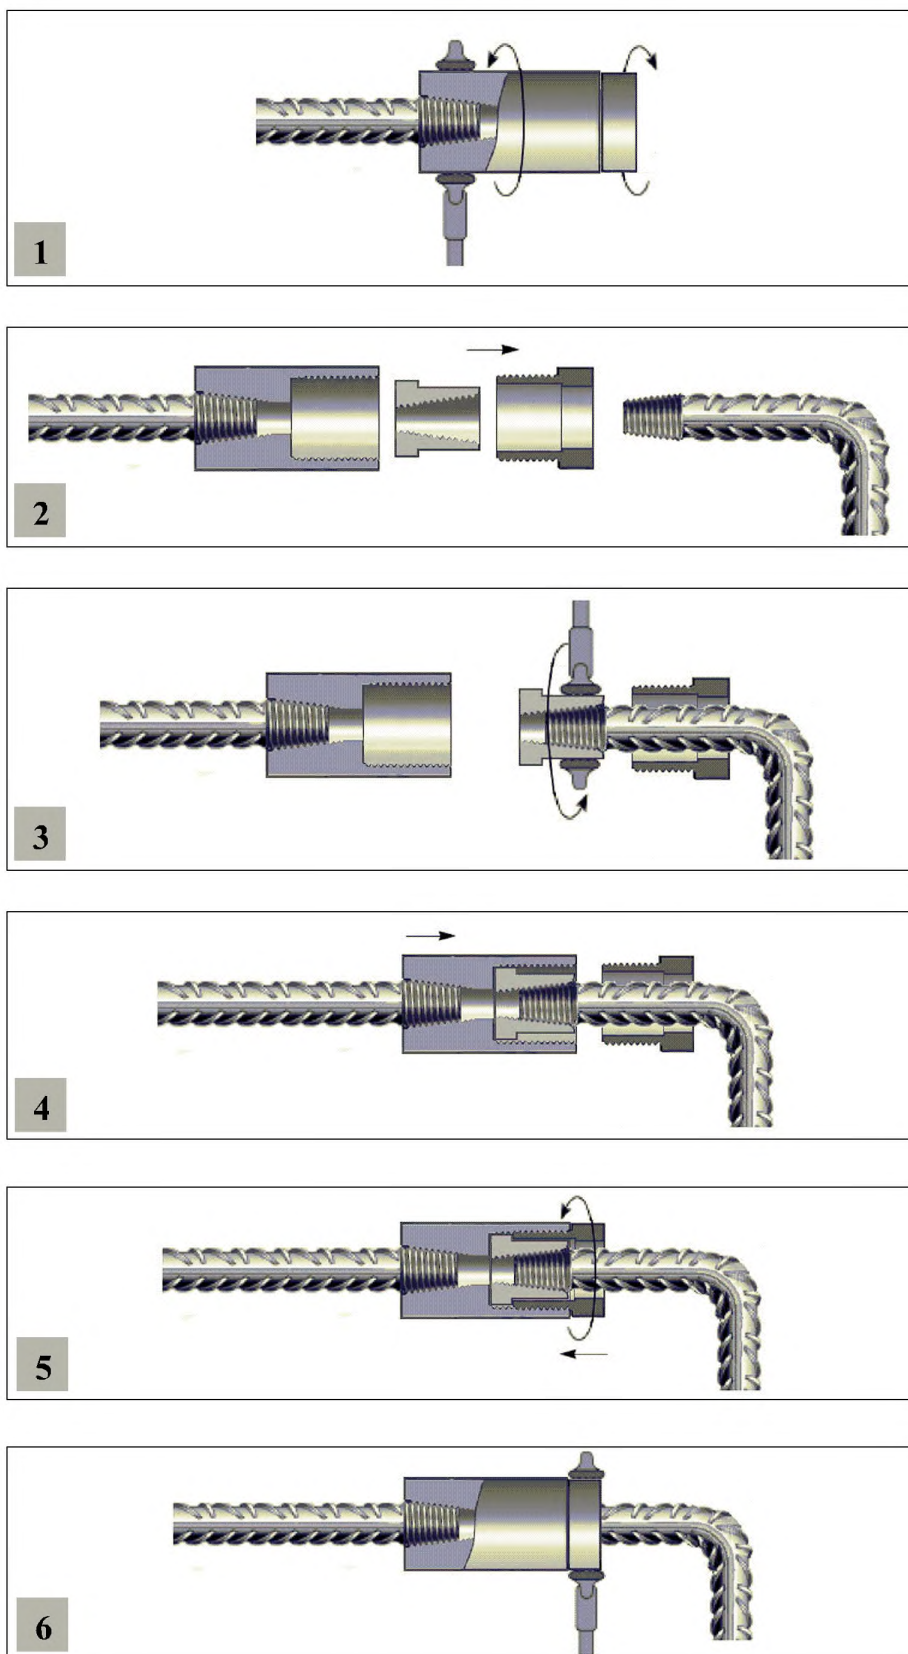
Сборка позиционного соединения тип 2 с конической резьбой
